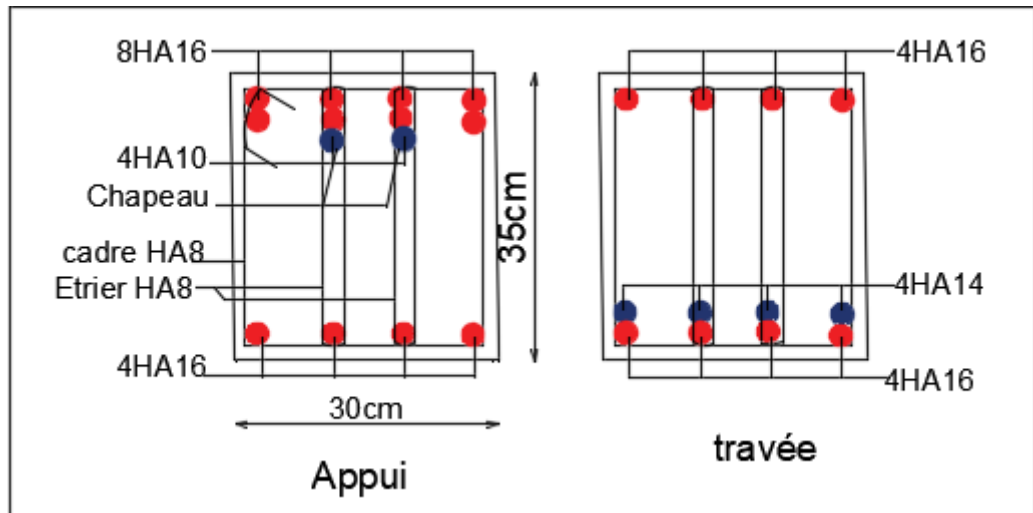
Schéma de ferrailage de la poutre secondaire du plancher étage 2
